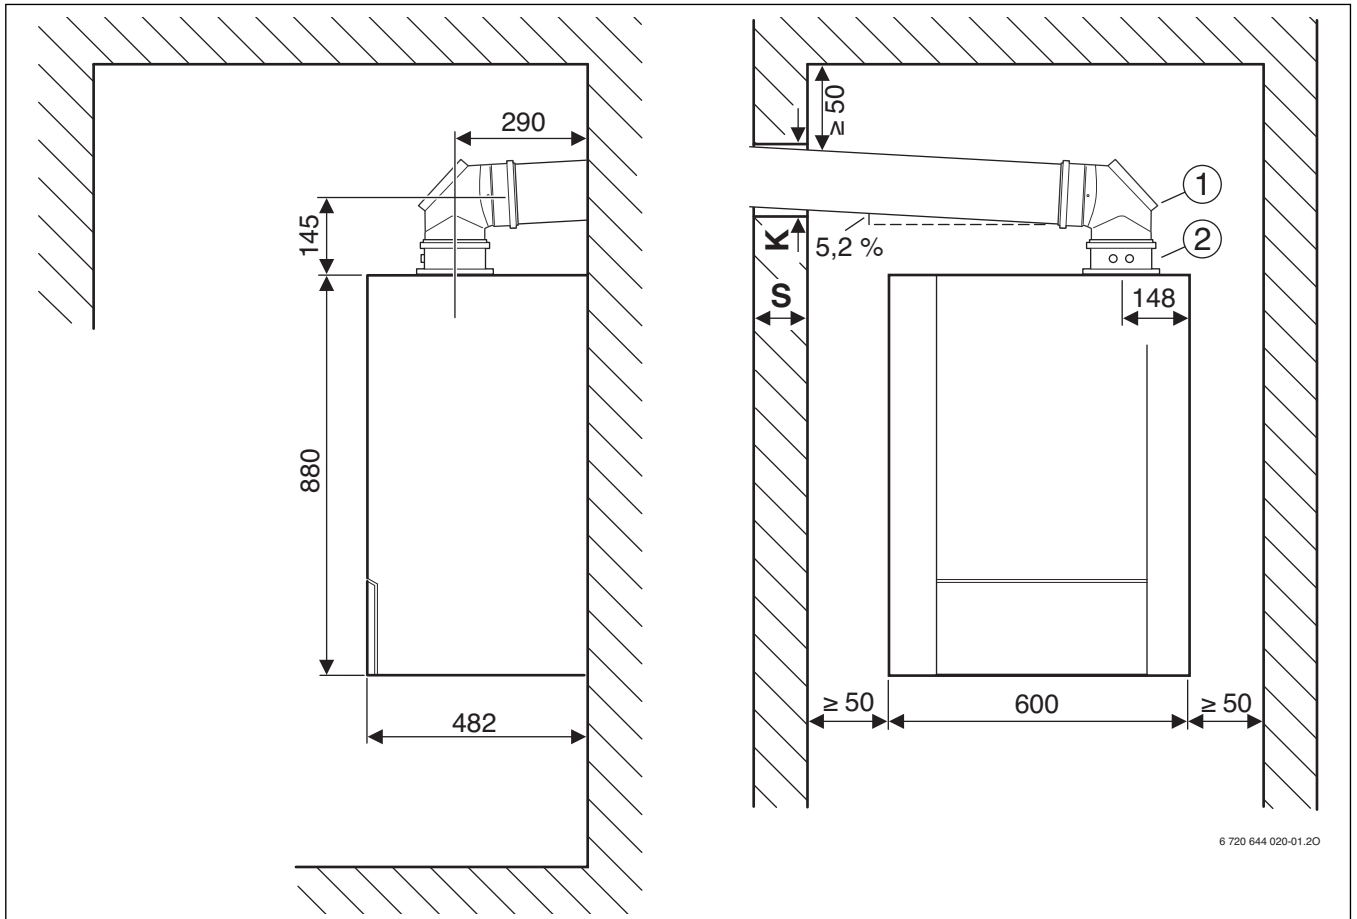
Abgasführung Ø 80/125 mm oder Ø 80 mm
